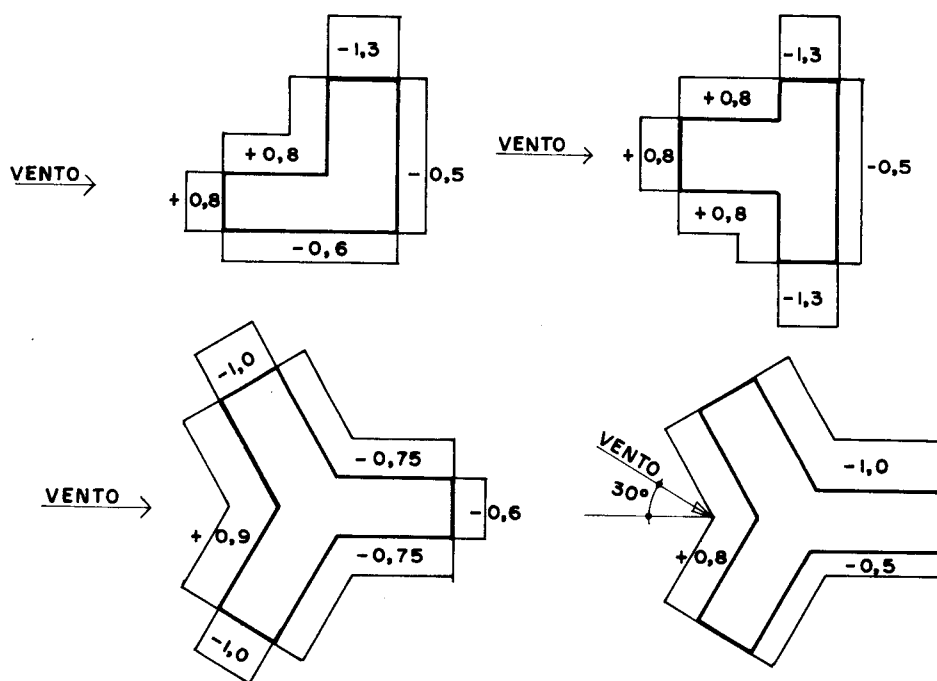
COEFICIENTES DE PRESSÃO EXTERNA  $C_{pe}$ : CONSTRUÇÕES DE PLANTA EM L, T e Y.
